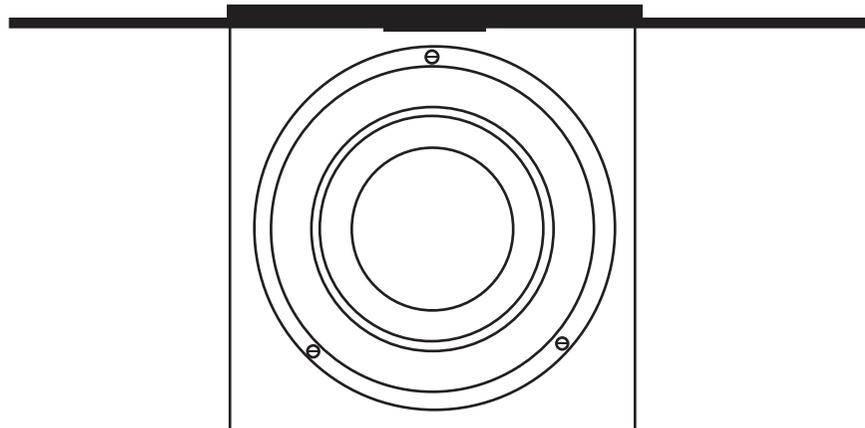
Vista en planta de la argolla inmersa en un pequeño desnivel adosado a la banqueta
